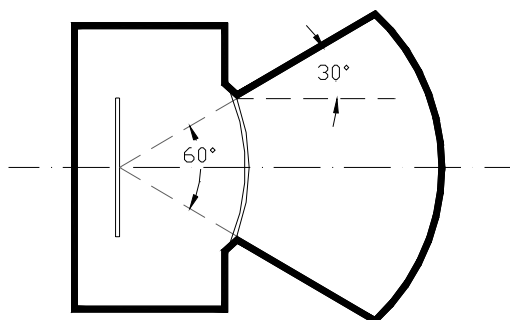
Planta esquemática - Inclinação das paredes laterais
